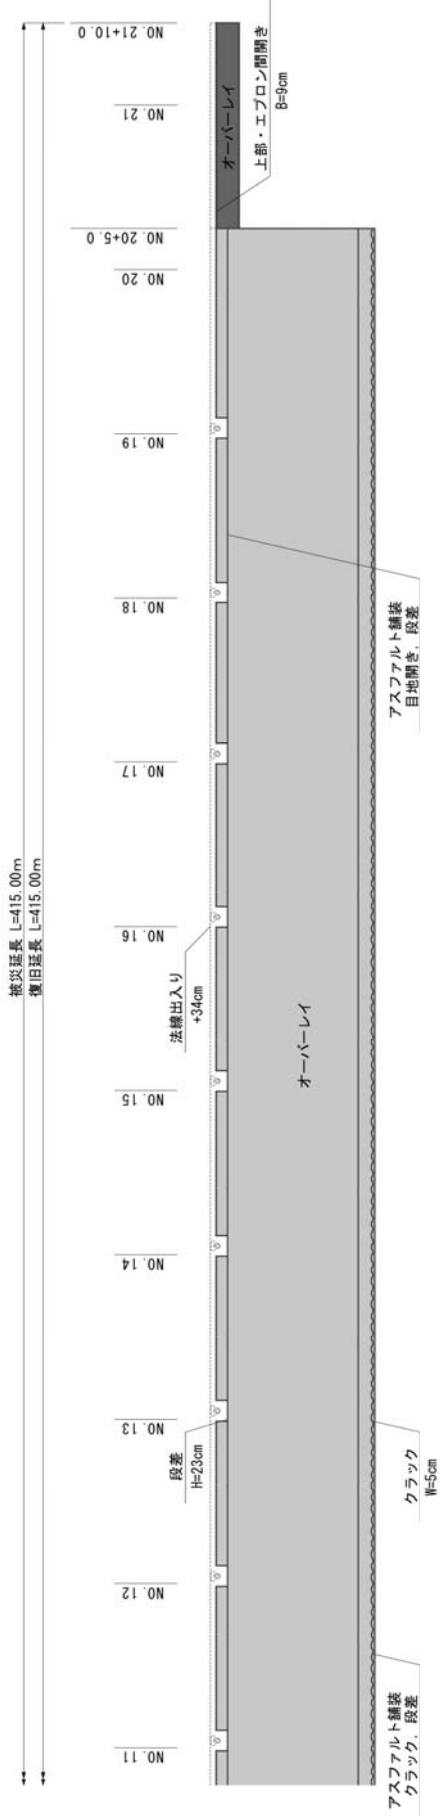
(a) 香椎パークポート地区北-7.5m 岸壁の復旧後平面図
